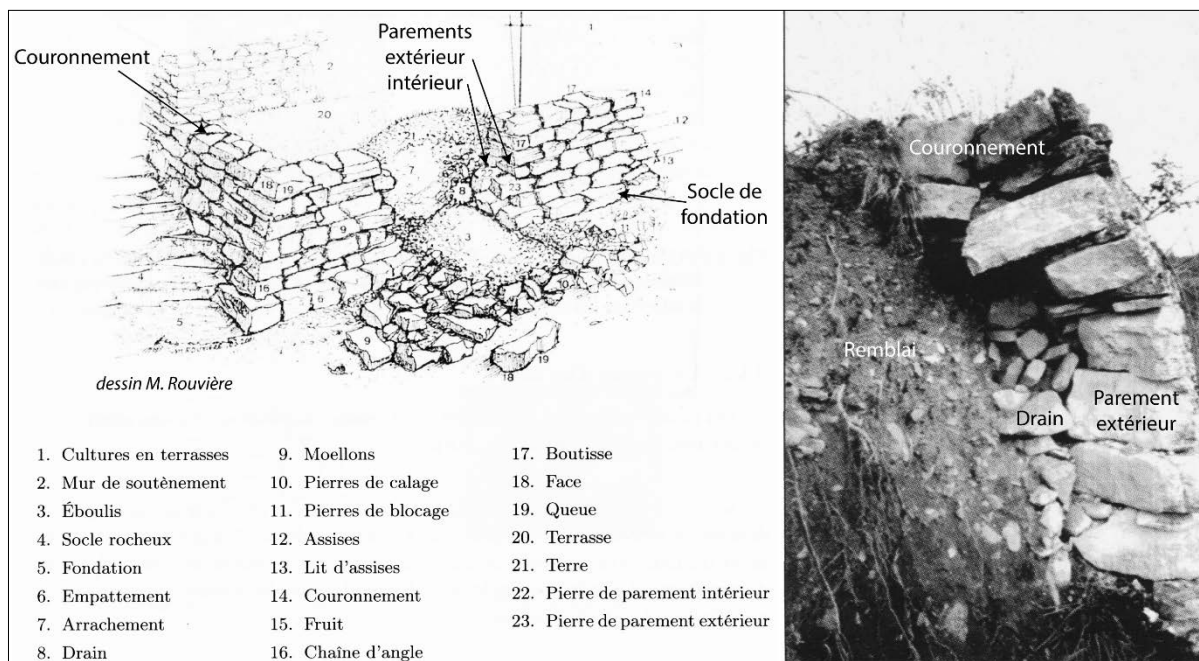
Lexique d'un mur de soutènement à double parement à gauche (d'après CAPEB 2008), coupe d'un mur de soutènement à simple parement extérieur à droite (d'après Lassure 2008).
